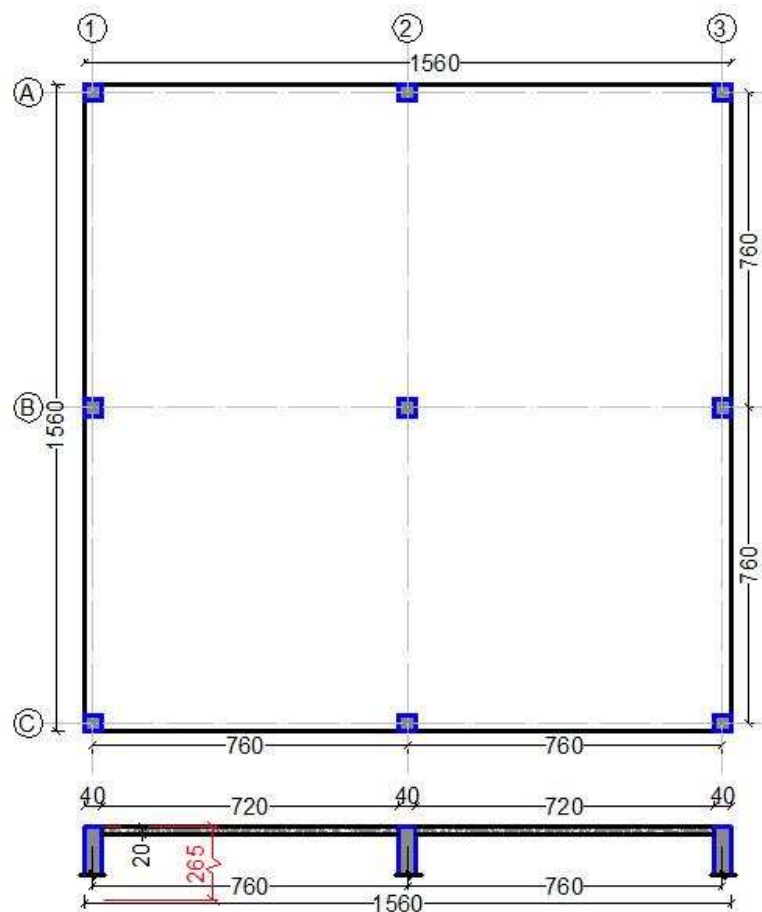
Planta baixa e elevação da FÔRMA_3
